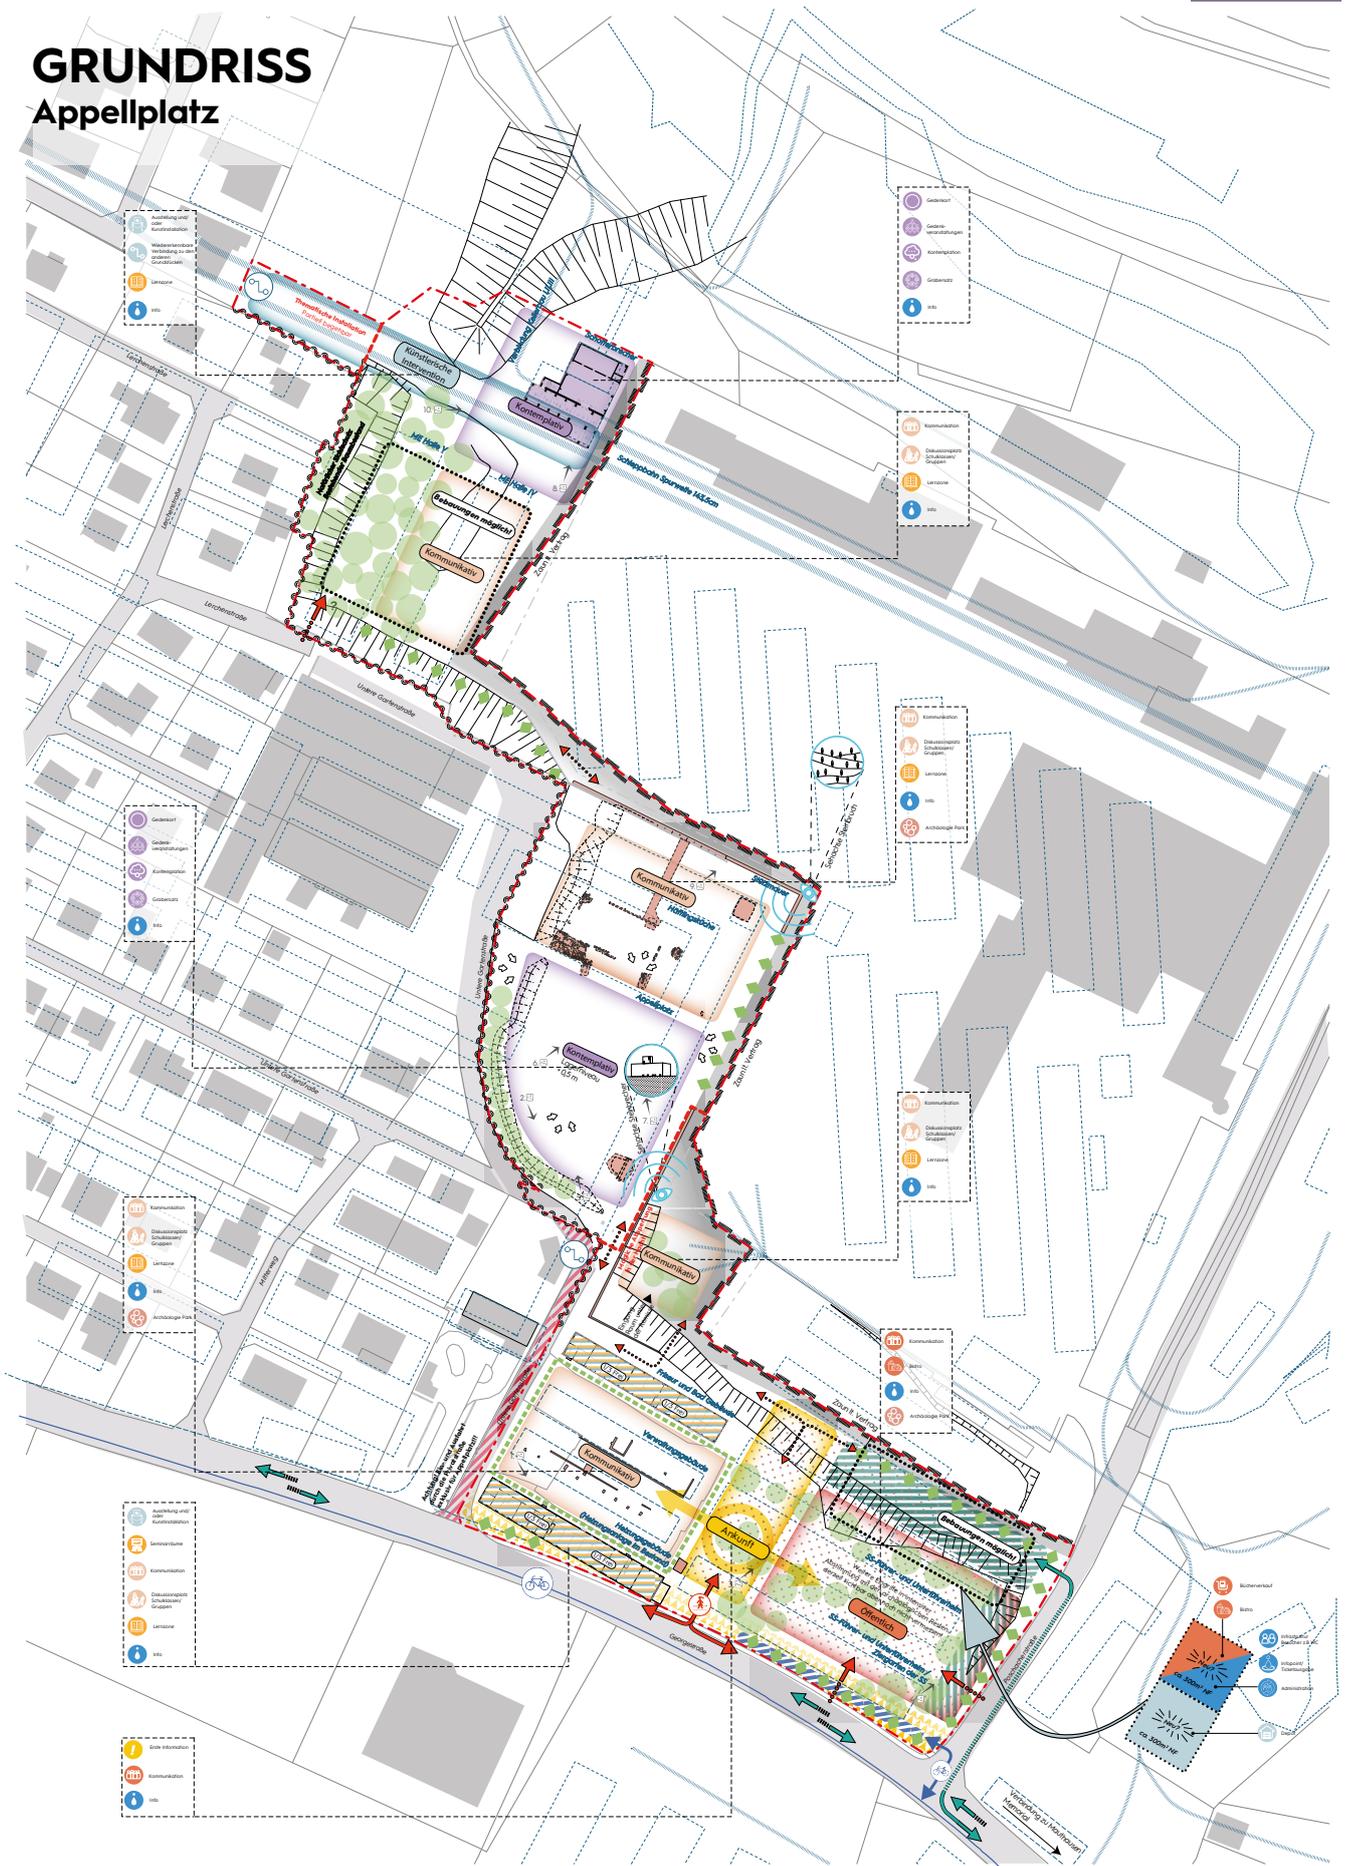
Masterplan Grundriss Appellplatz
